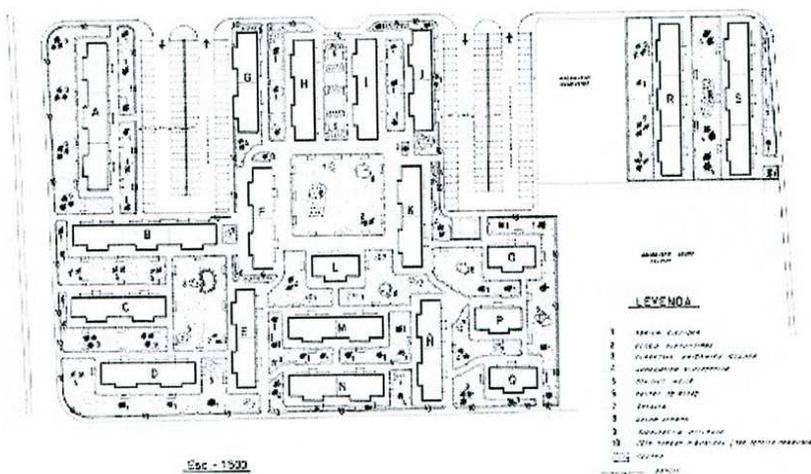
Plano de distribución del conjunto, con el detalle de la jardinería.
